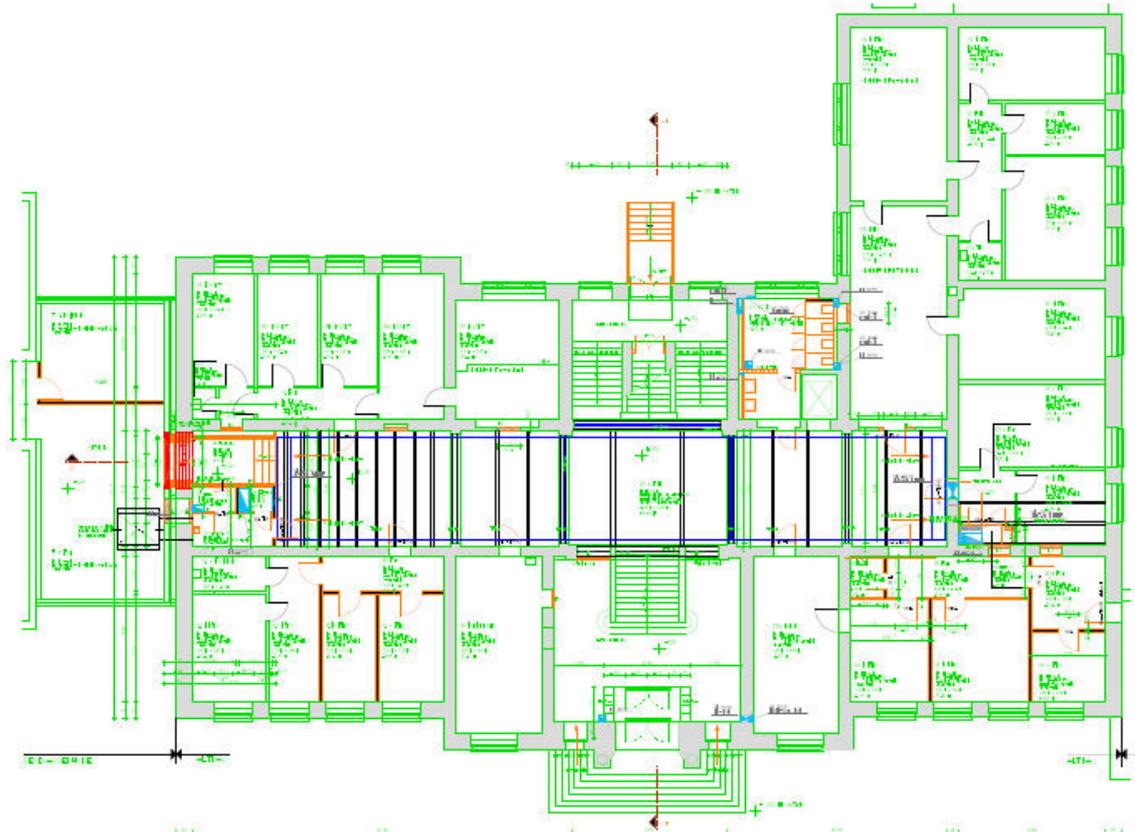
Grundrissplan EG, Gebäude HD
